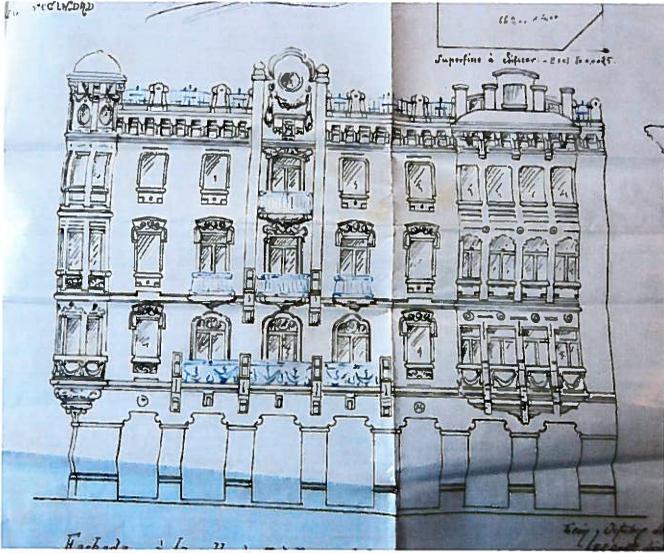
Casa Alfageme. Plano de Fachadas.
